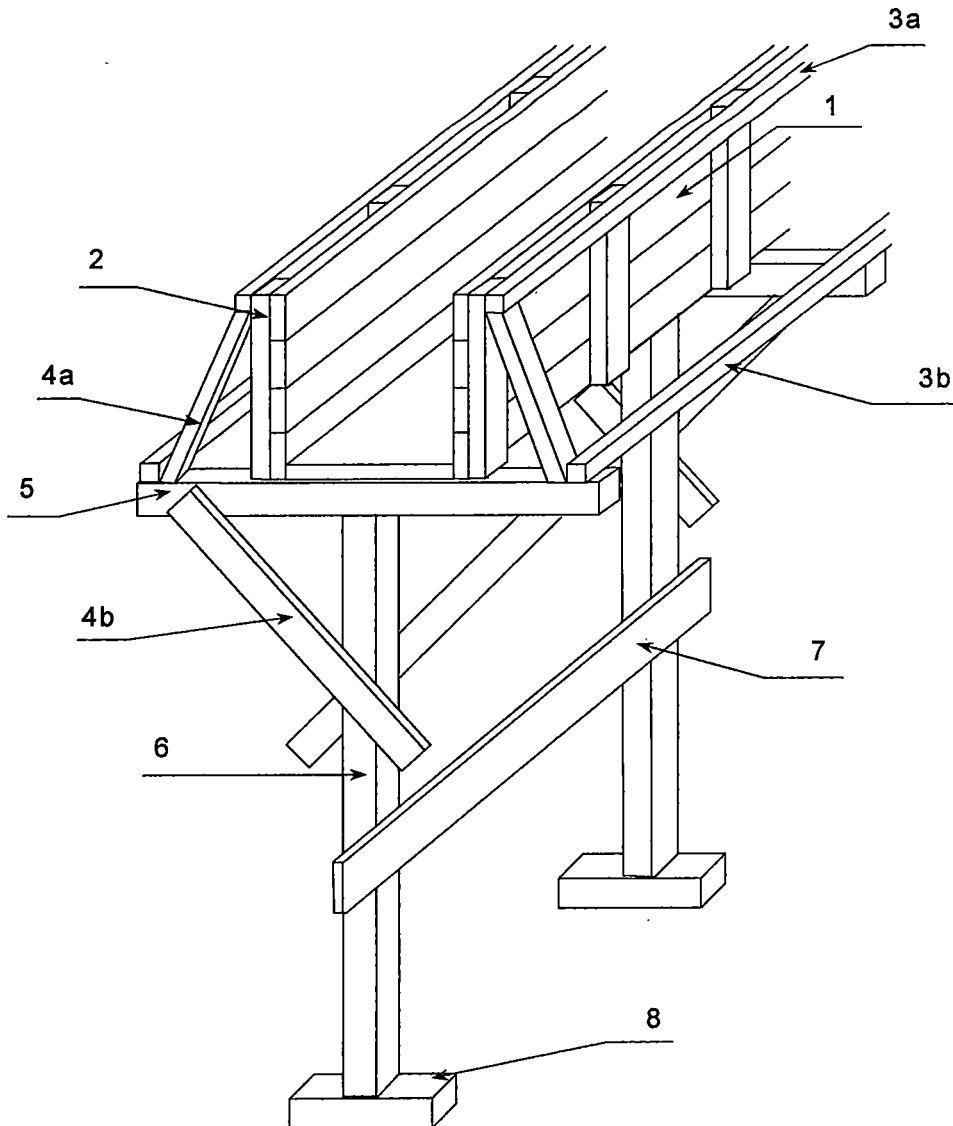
Encofrado de viga de concreto convencional (típica).
